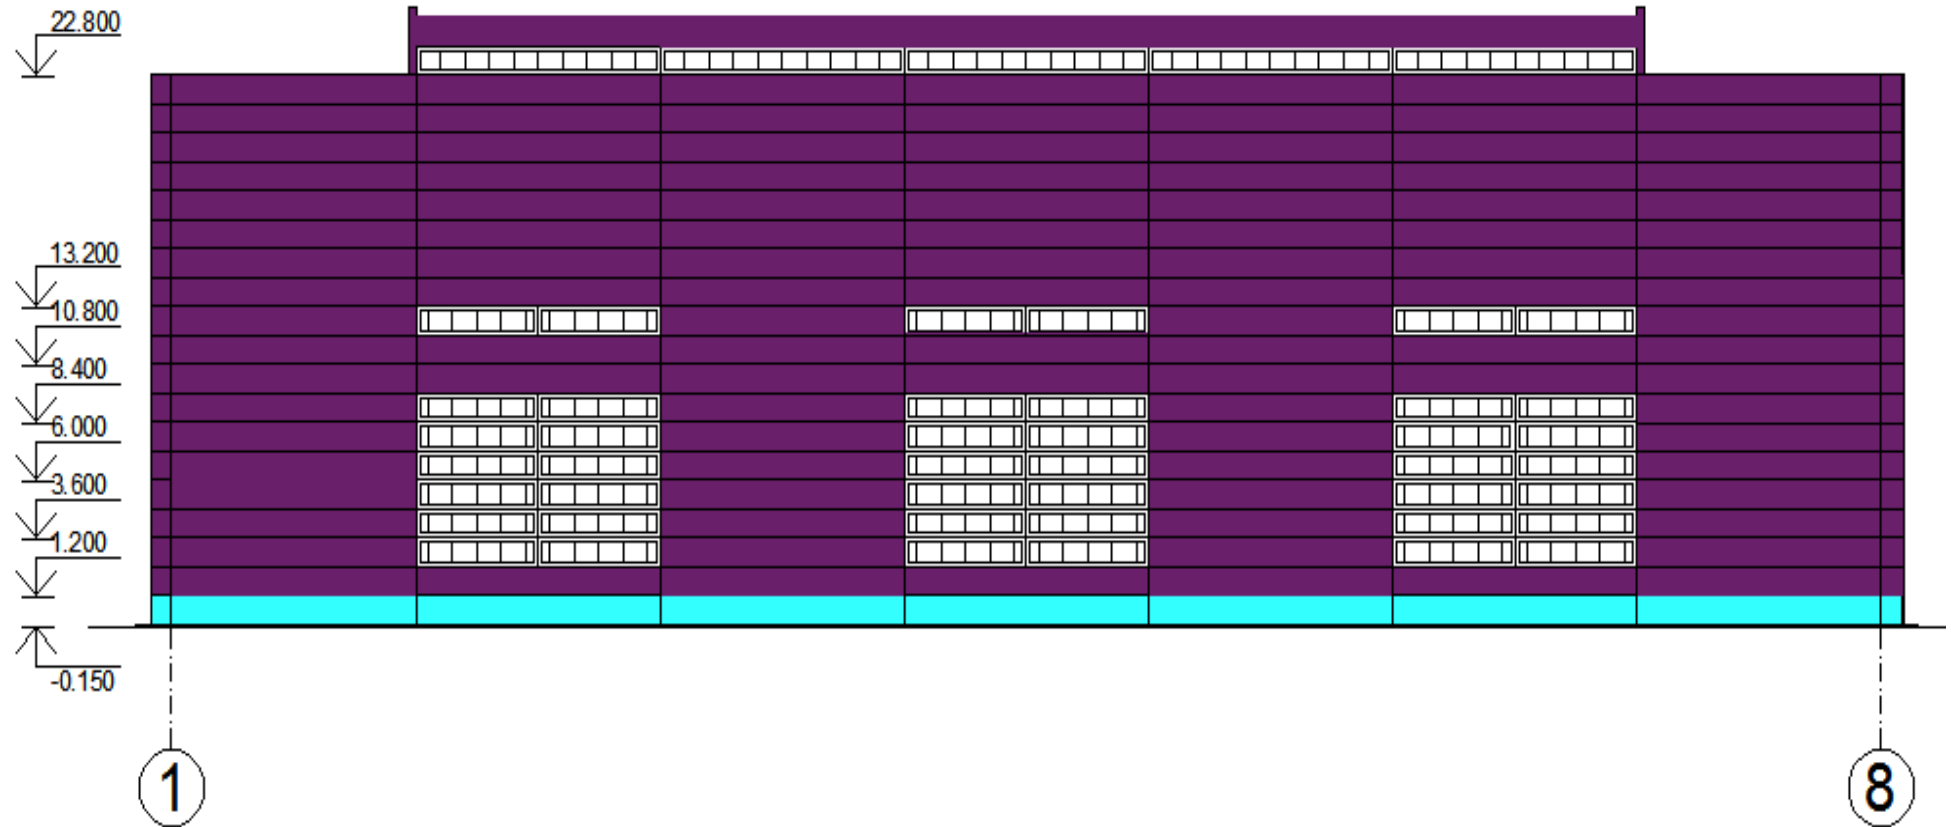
Фасад арматурного цеху у вісях 1 - 8
